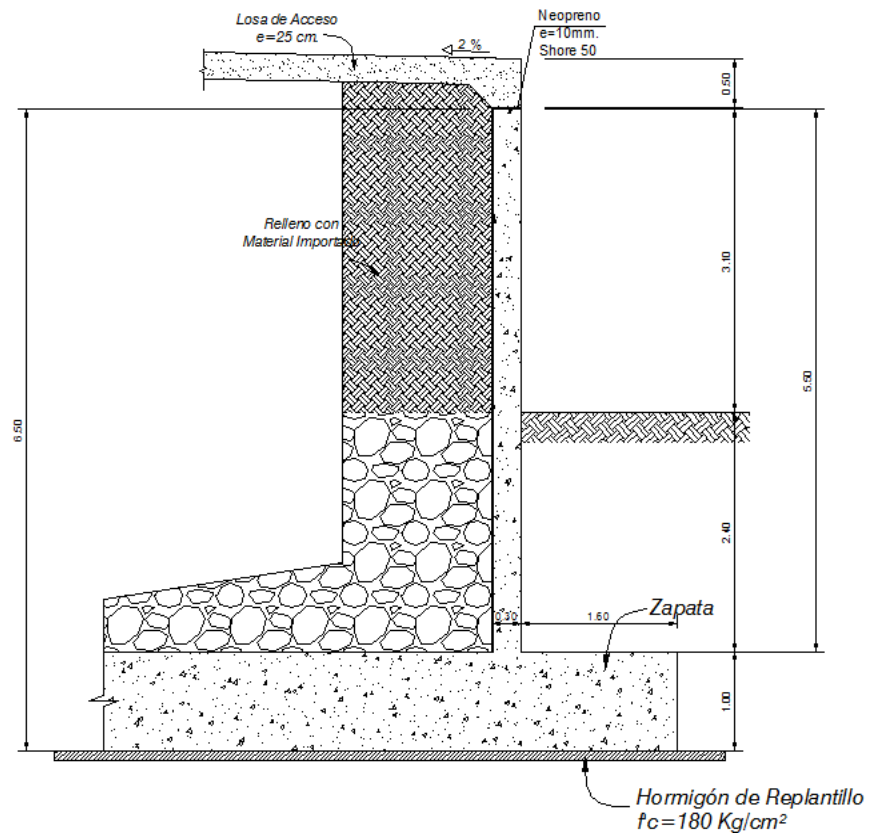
Elevación lateral del muro de acompañamiento del estribo E1.
